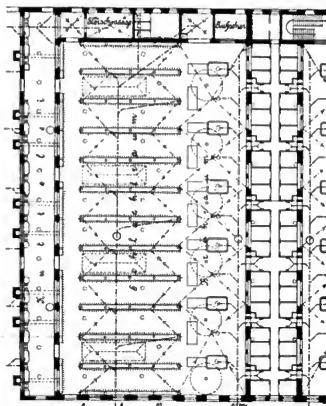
Schweine-Schlachthalle. Halber Grundriss.
